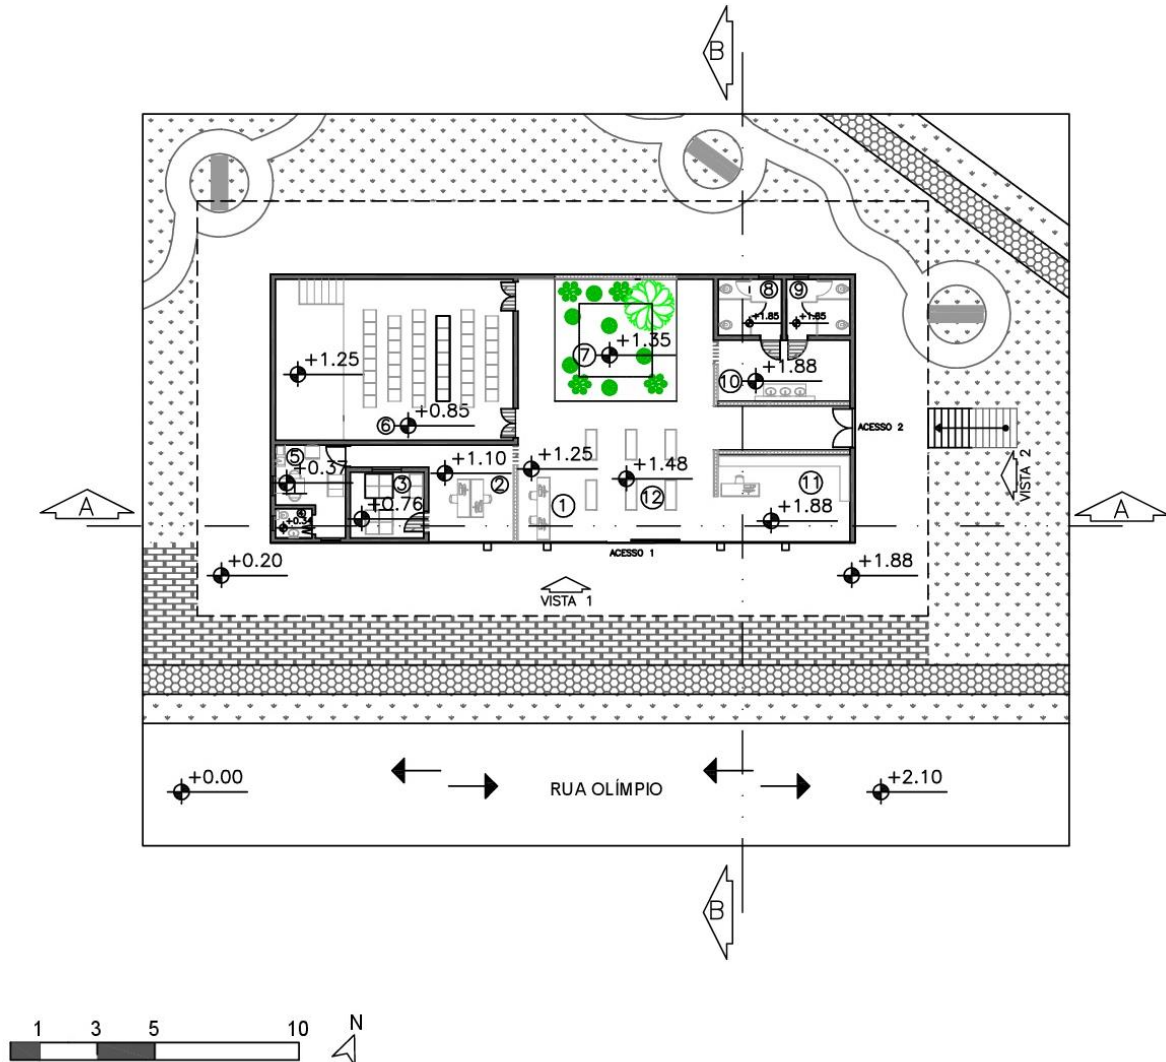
Planta baixa centro turístico – Por Eloísa Bussi Fernandes
